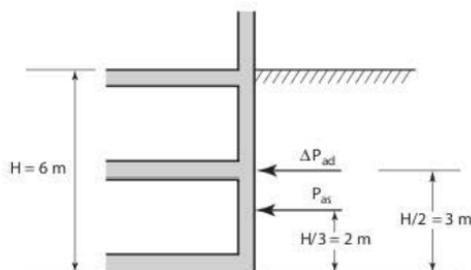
Poussées sur une paroi d'infrastructure
